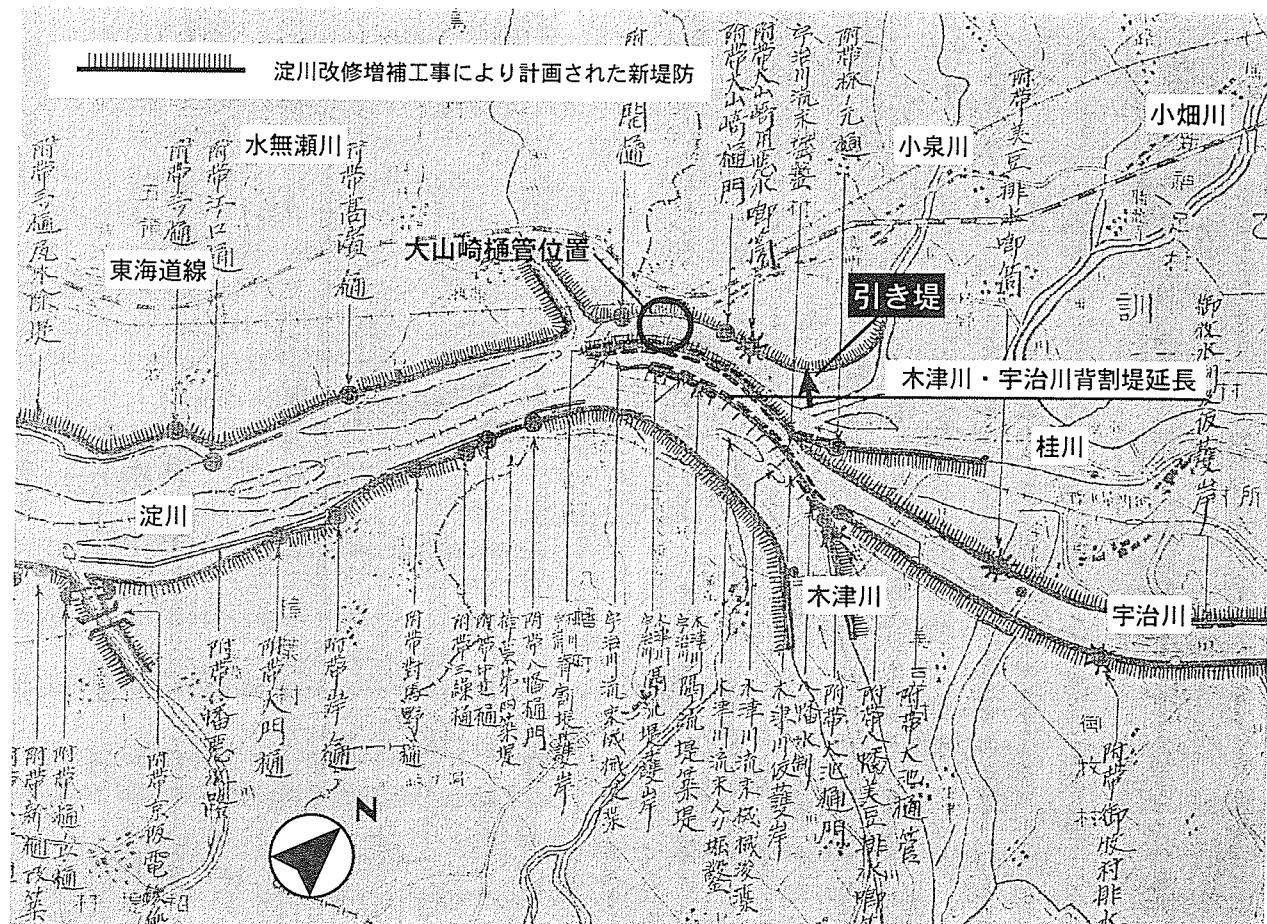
淀川改修増補工事平面図（淀川資料館蔵）
